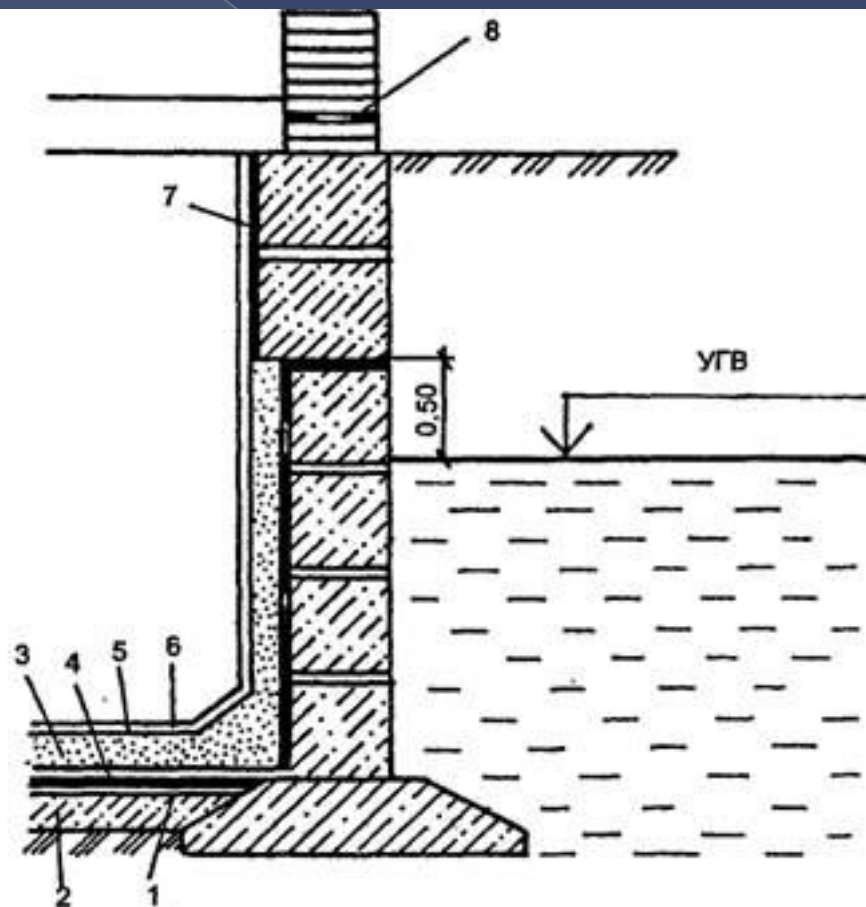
Гидроизоляция подвала при больших напорах грунтовых вод:
